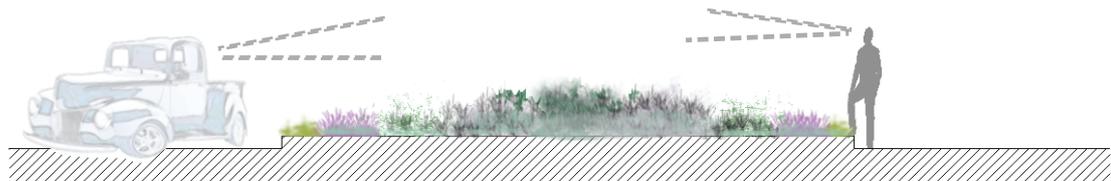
Corte esquemático da proposta de plantação da rotunda.
